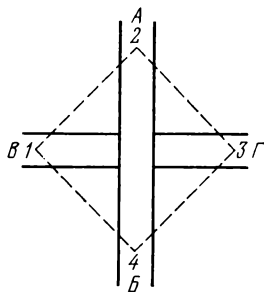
Схема расположения двух опор наружной пирамиды под крышей и двух — над крышей здания
